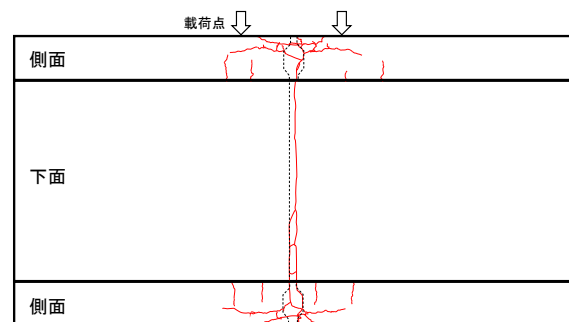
凹凸型試験体接合部ひび割れ進展状況
